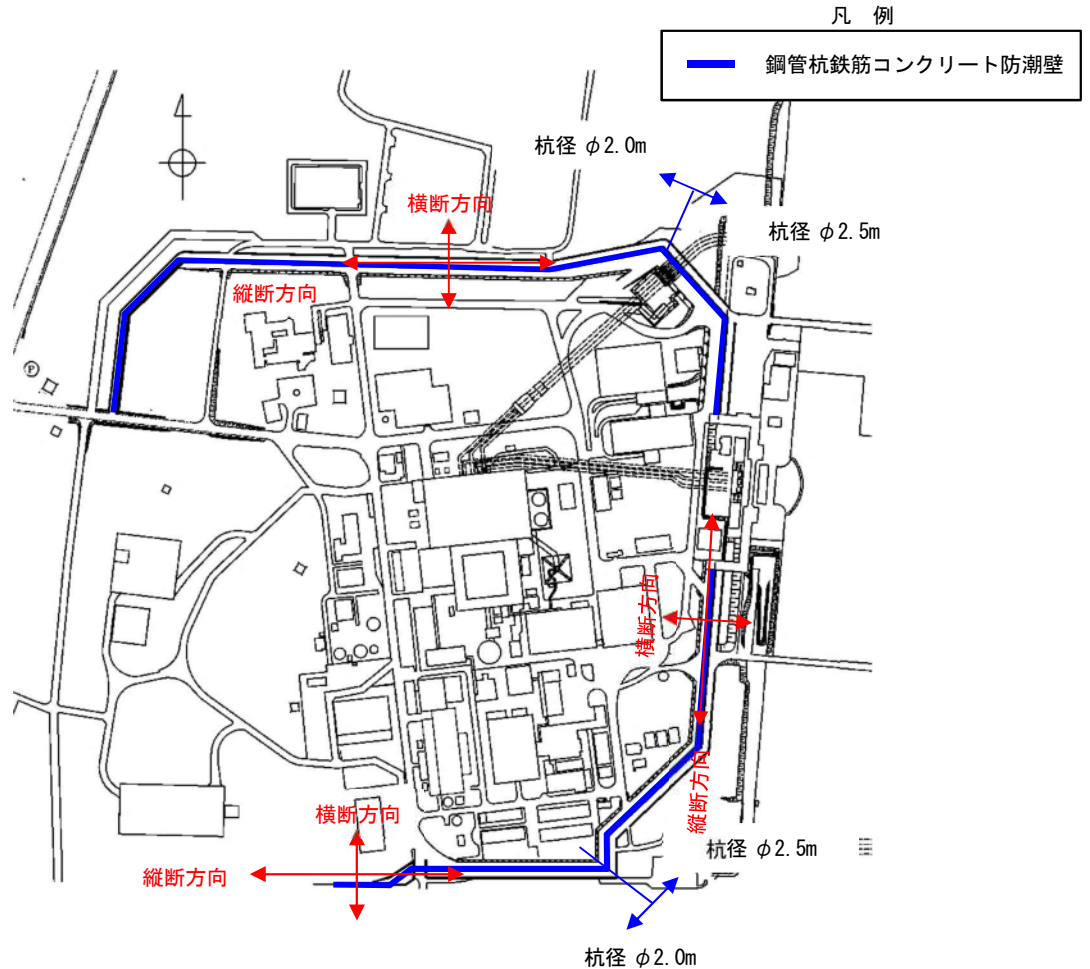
鋼管杭鉄筋コンクリート防潮壁の平面配置図
